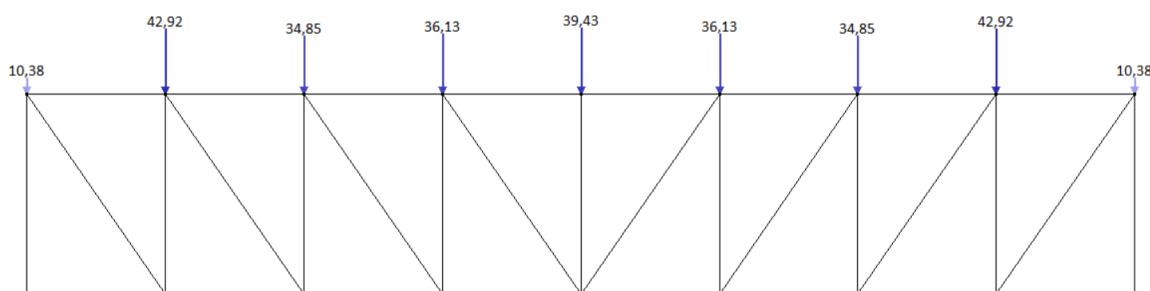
Aplicação dos carregamentos no sistema de contraventamentos.
